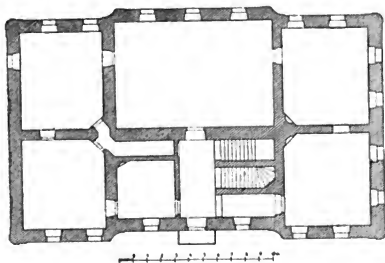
Tereschau. Grundriss des Schlosses.
